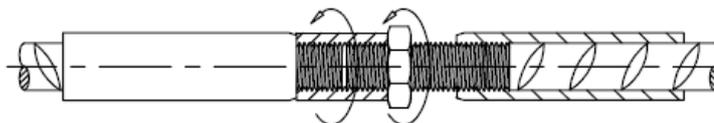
POSITIONSVERBINDUNG (PI) (Alternativ)
